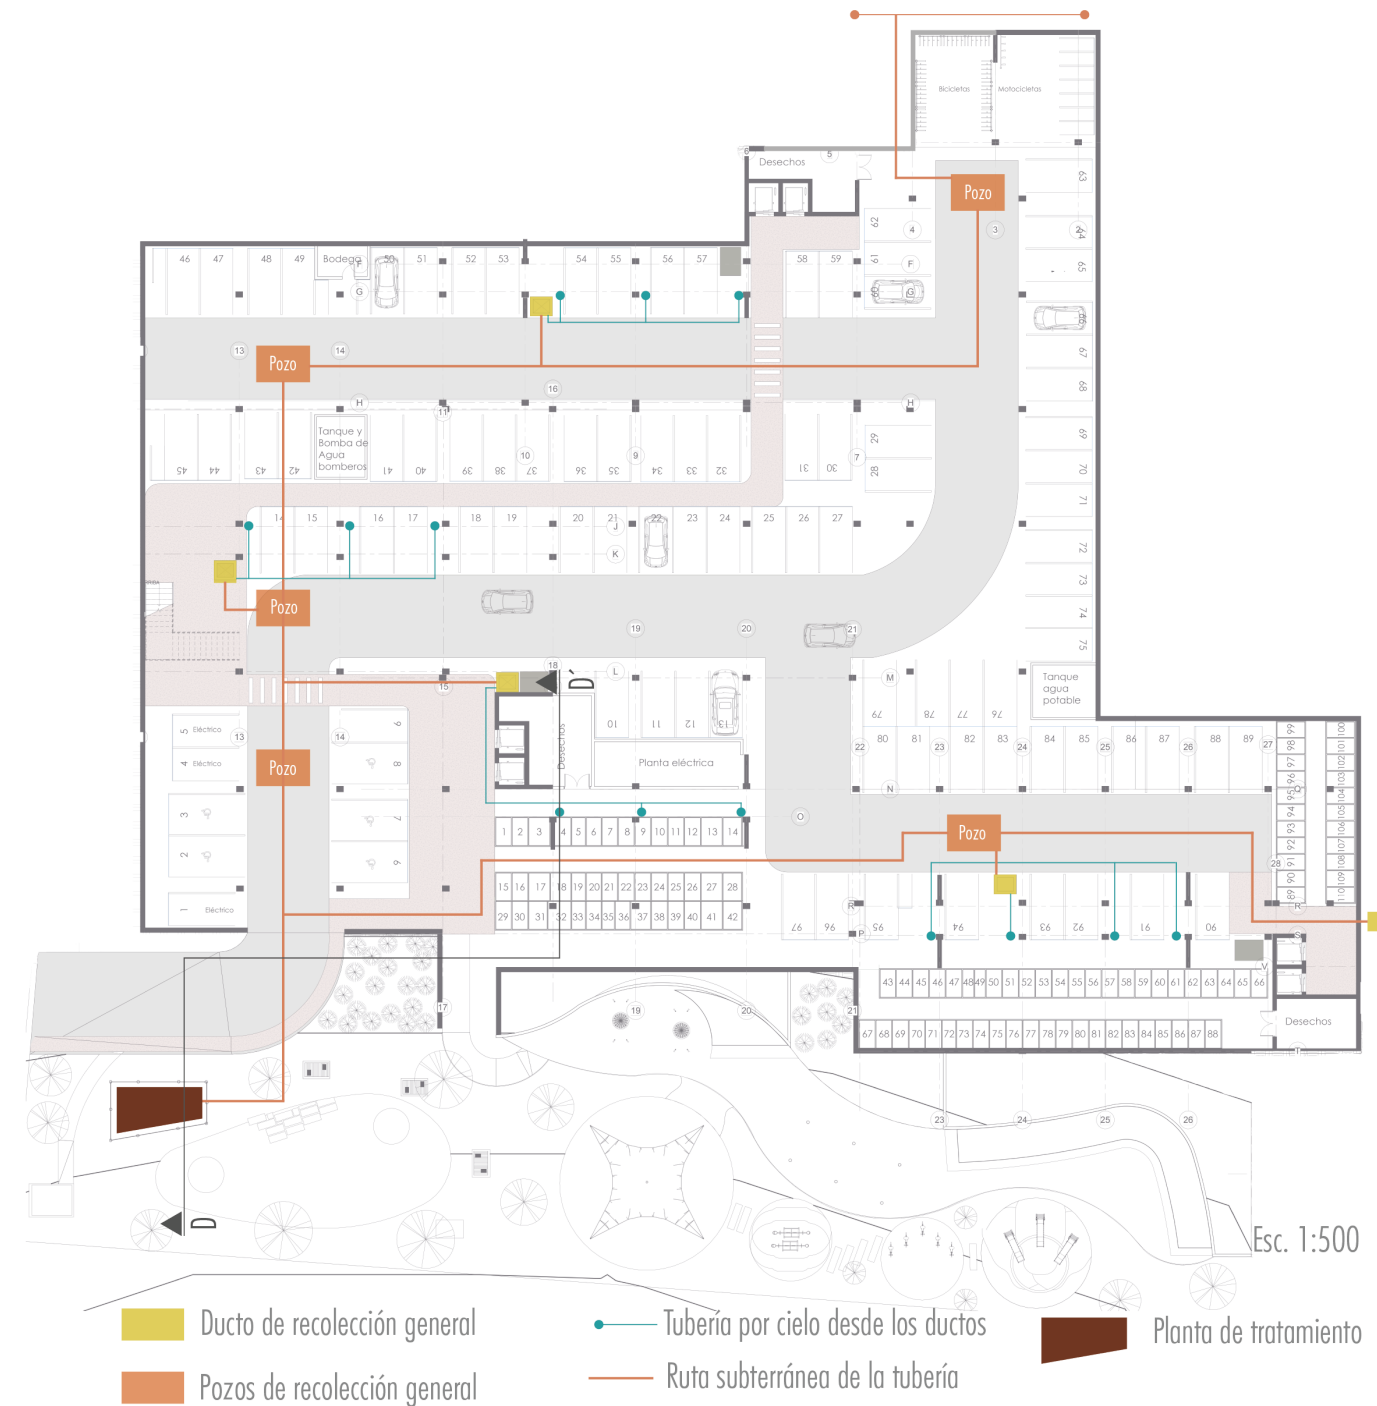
Planta instalaciones mecánicas. Elaboración propia.
